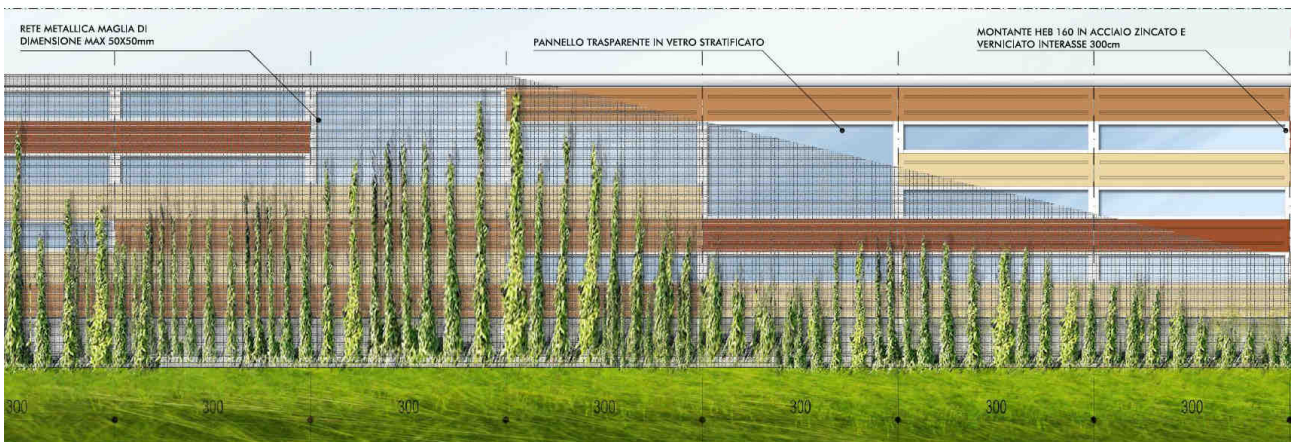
SEZIONE TIPOLOGICA DELLA BARRIERA ACUSTICA MISTA FONOASSORBENTE-FONOISOLANTE SU RILEVATO
